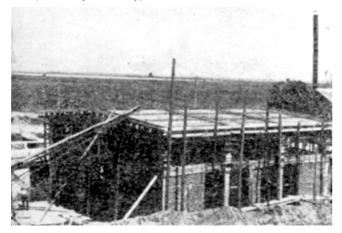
Stația nouă de pompare de la Rudna, în construcție
